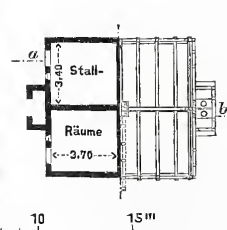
Wärter-Stallgebäude. Grundriss.
